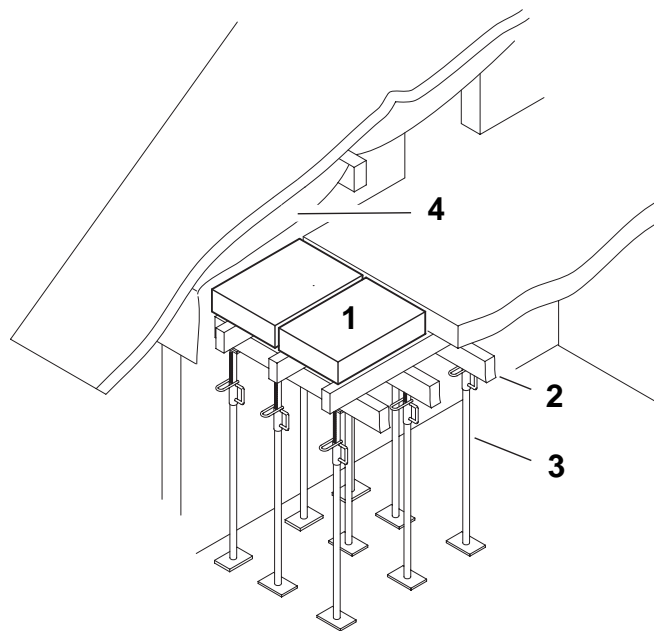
Aseguramiento de los bloques de construcción con apuntalamientos
